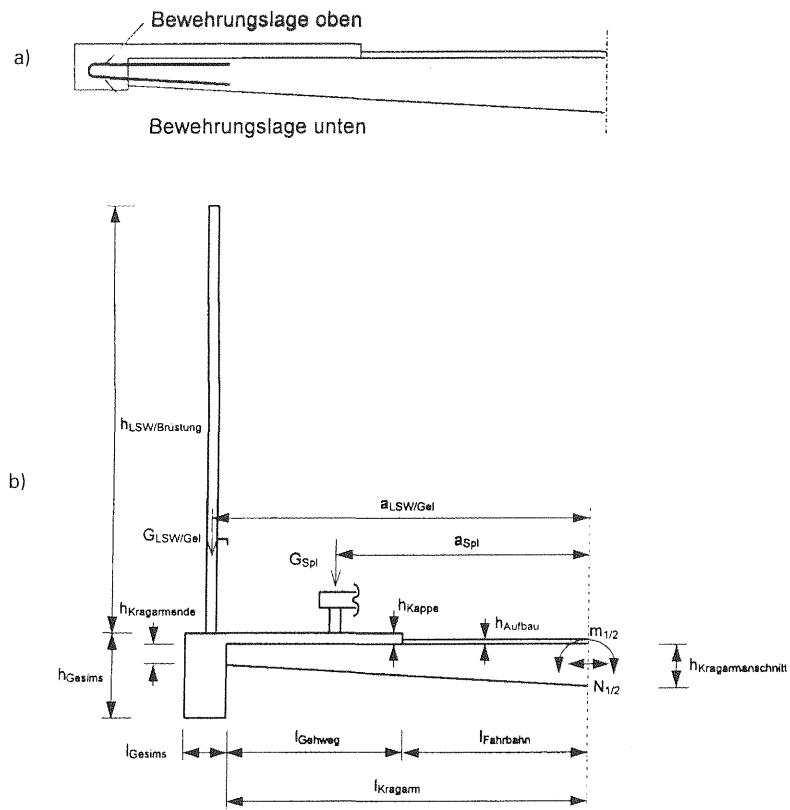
Bemessung der Kragarme; a) Bewehrungsanordnung, b) Schnittgrößen
